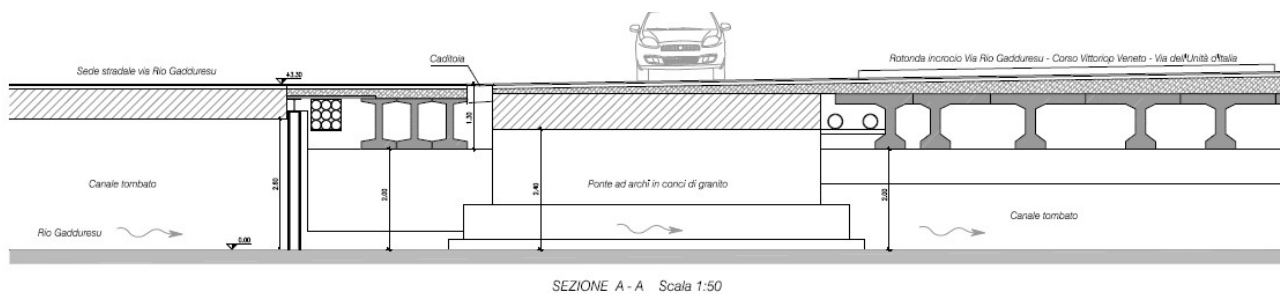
estratto da tav 2 progetto definitivo 'Demolizione e ricostruzione ponte sul canale tombato di Corso Vittorio Veneto': stato di fatto
